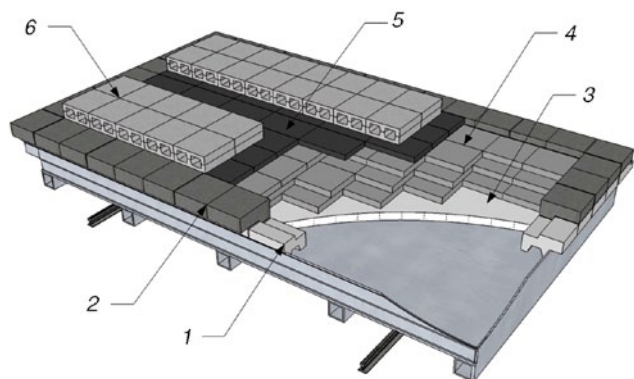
Конструкция футеровки вагонетки с использованием жаростойкого бетона на шлакощелочном вяжущем и плитных теплоизоляционных материалов (разработка УралНИИСтром): 1 – нижний ряд окантовочных блоков из жаростойкого бетона; 2 – верхний ряд окантовочных блоков из жаростойкого бетона; 3 – стяжка из легкого теплоизоляционного вермикулитобетона; 4 – плитные изделия из вермикулита; 5 – подовые плиты из жаростойкого бетона; 6 – канализованный под из жаростойкого бетона
